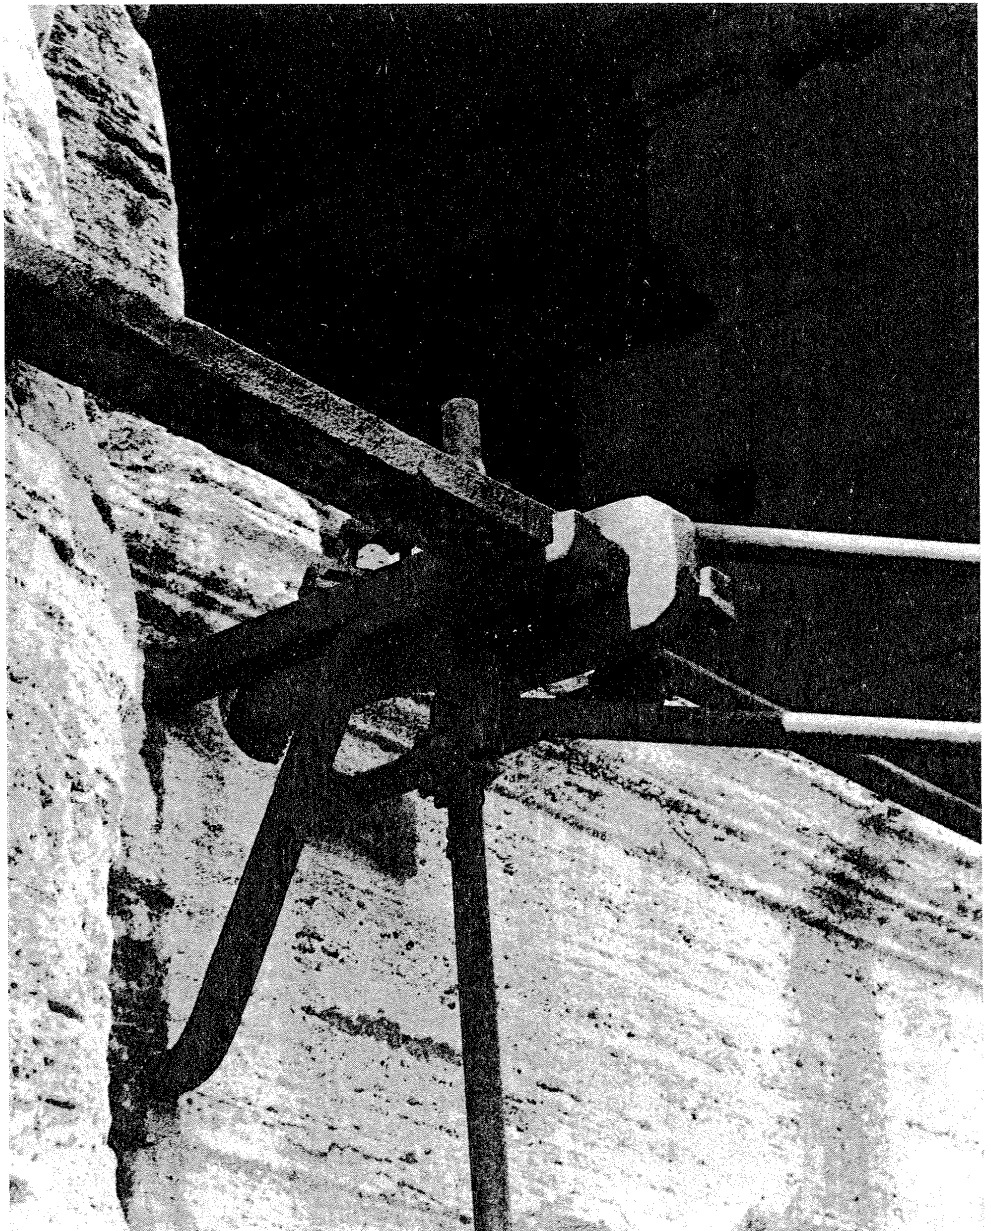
Particolare dell'ancoraggio al prospetto esterno
